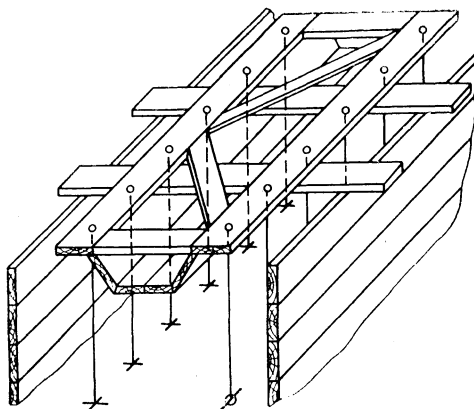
Способ установки анкерных болтов в массиве фундамента
